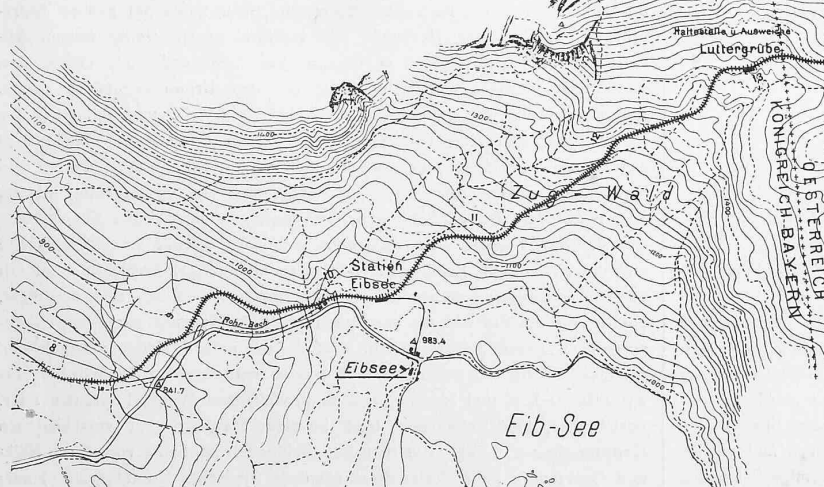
Lageplan der Zahnstangenstrecken und der Seilbahnstrecken von Badersee über Ehrwalder Köpfe bis Zugspitze.
